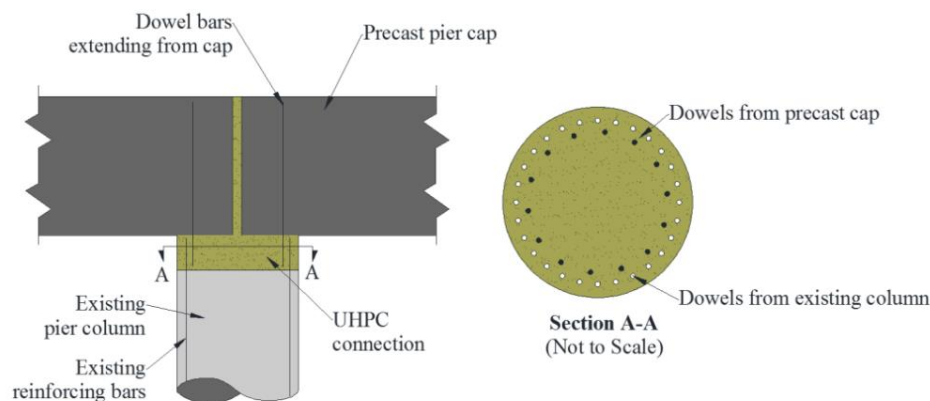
Ligações realizadas com UHPFRC entre um pilar de uma ponte existente e um novo elemento pré-fabricado [28].
